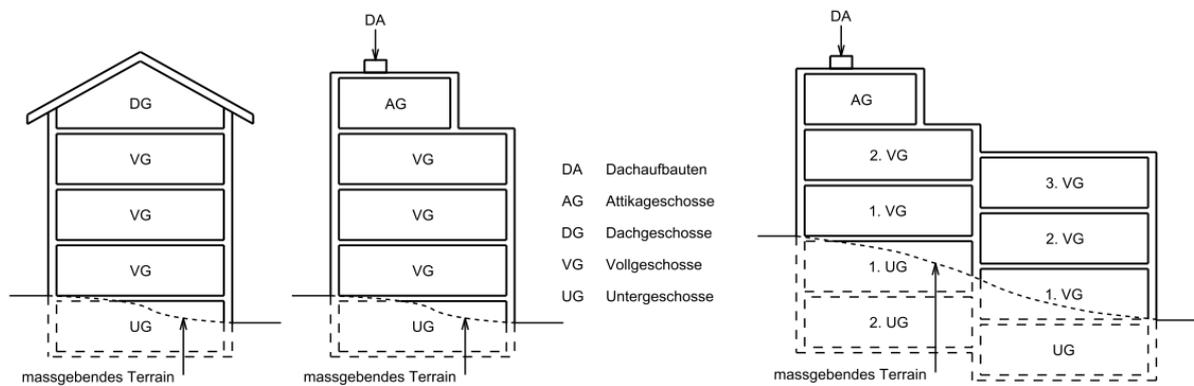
Figur 6.1 Geschosse und Geschosshöhe, IVHB
